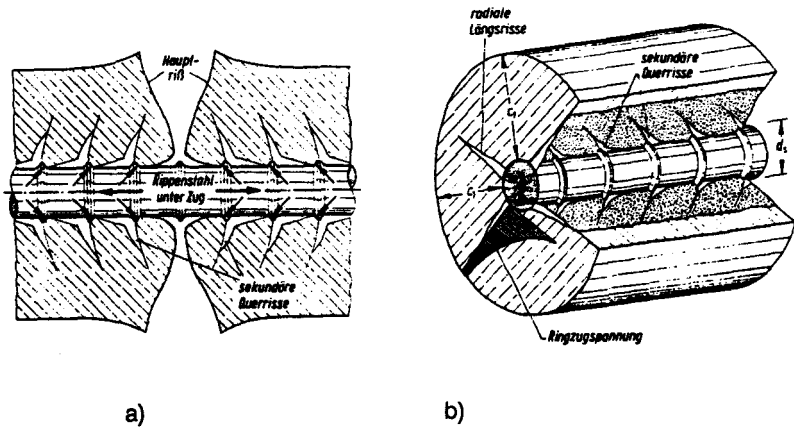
Übertragung der Verbundkräfte und Bildung sekundärer Quer- und Längsrisse bei direkt einbetoniertem Betonstahl unter zentrischem Zug (aus [73])
